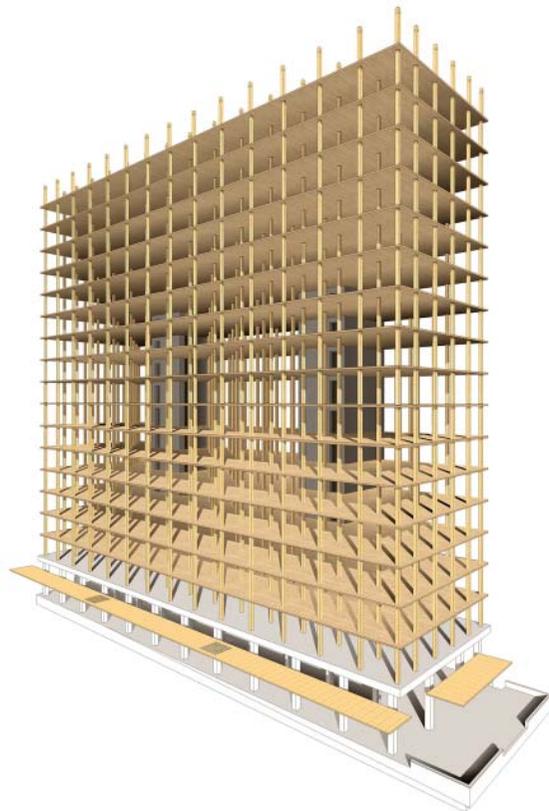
Konstruktion, Gebäudeaussteifung & Fassade. Aussteifung durch zwei Erschließungskerne aus Beton. Brettschichtholzstützen und fünfschichtigen Brettschichtholzdecken mit Stahlverbindern. Betonstruktur und CLT Vordach an der Basis. Verkleidete Holzstruktur in den Regelgeschossen. exponierte Holzstruktur im Studenten-Raum.
